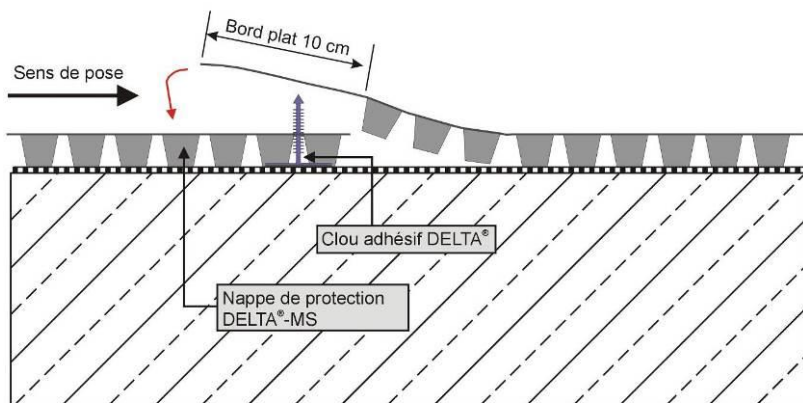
DELTA®-MS – coupe horizontale d'un recouvrement (pose verticale de la nappe à excroissances)
